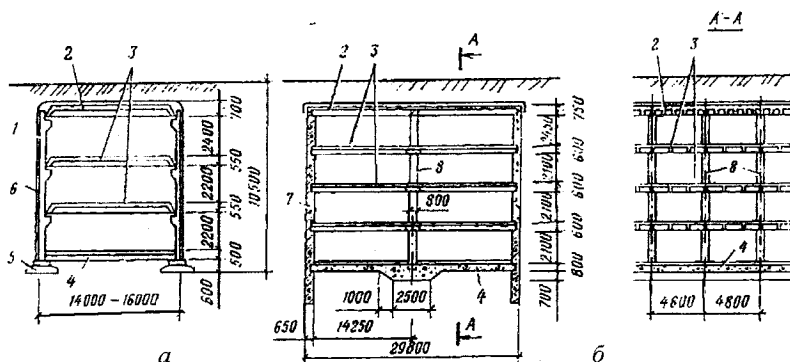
Конструкції підземних гаражів: а – однопрольотна; б – двохпрольотна; 1 – стіновий блок; 2 – верхнє перекриття; 3 – між'яруснє перекриття; 4 – лоток; 5 – фундамент; 6 – гідроізоляція; 7 – траншейна стіна; 8 – колони
